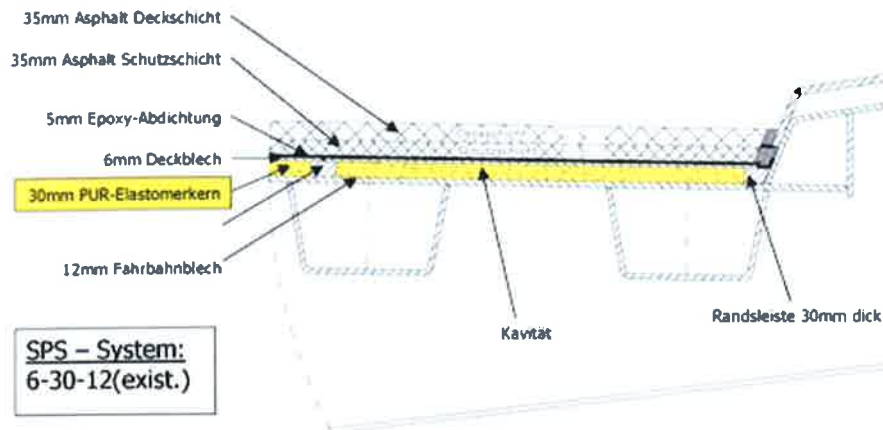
SPS-Querschnitt Fahrbahn Pilotprojekt Schönwasserparkbrücke
